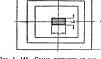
141. Схема нагрузок на внецентренно нагруженный фундамент.
